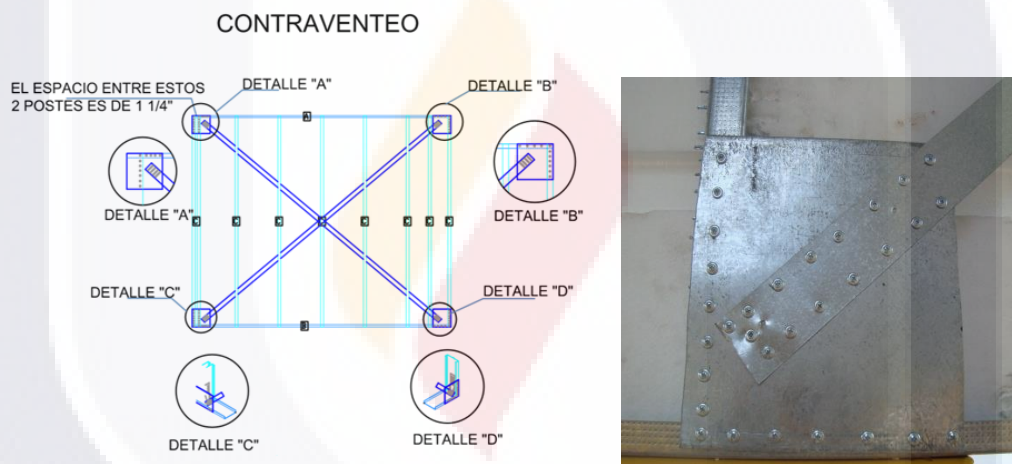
Estructuración del sistema de contravientos en muros (GBS, 2013)
